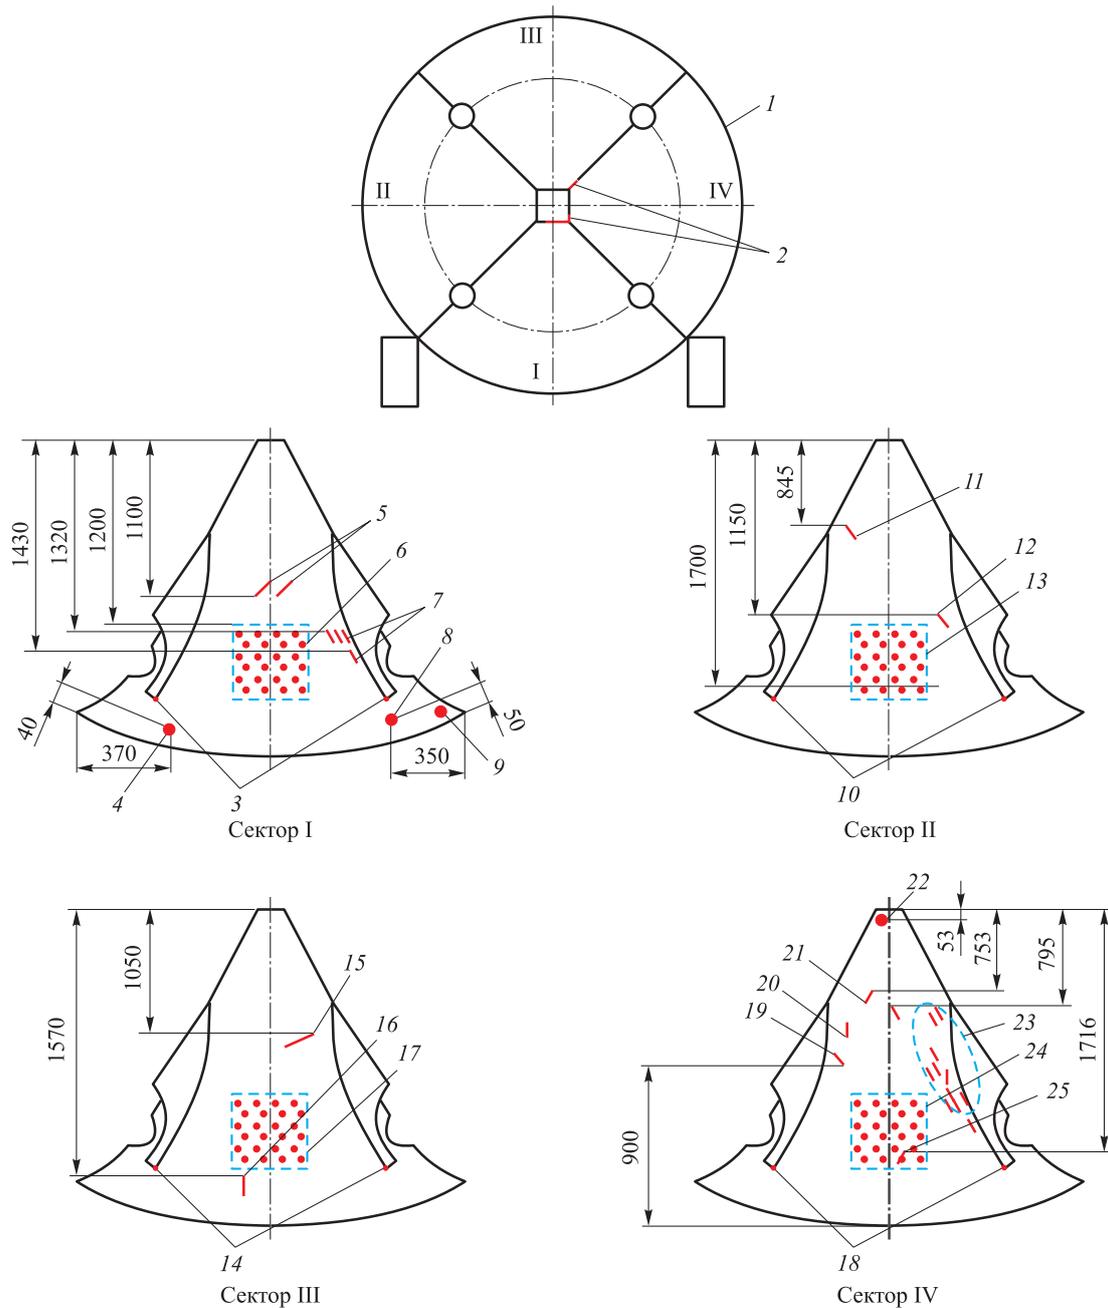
Схема расположения дефектов газоотражателя агрегата 11У28Р.0801:
